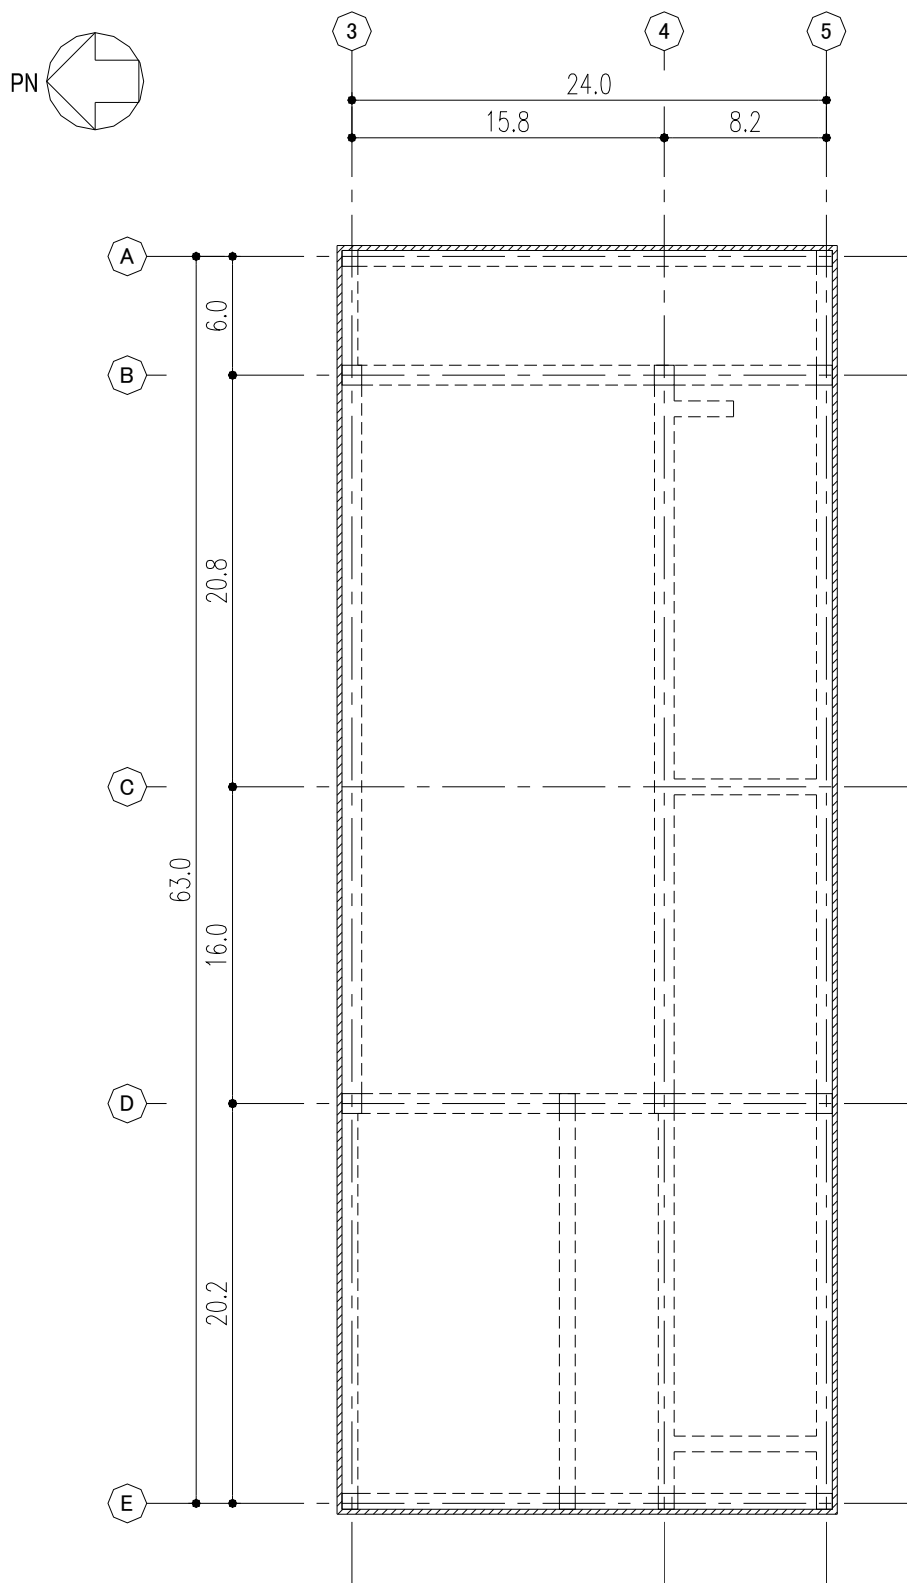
スラッジ棟 屋根平面図 (O.P. 45. 5) (単位 : m)
